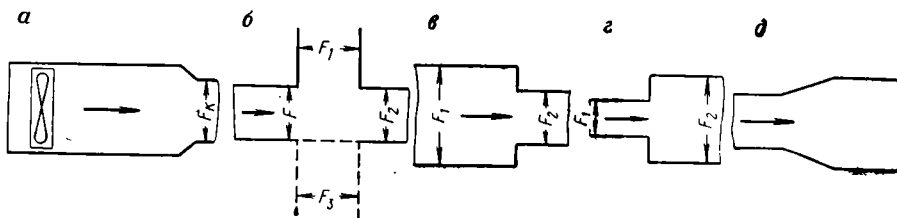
VIII. Элементы сети тоннельной вентиляции
